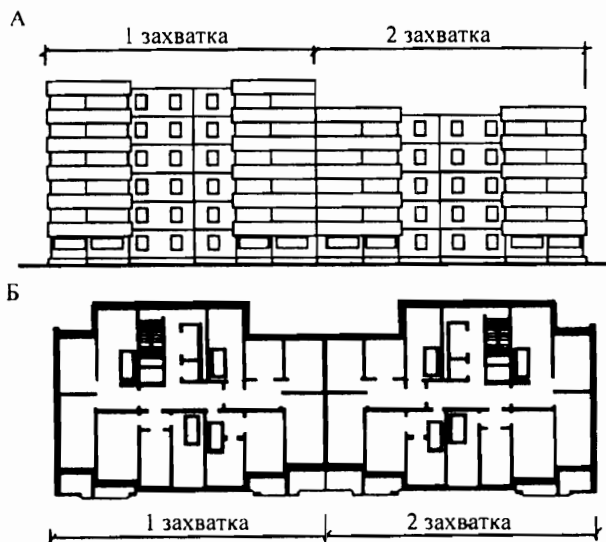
Схема разбивки многоэтажного двухсекционного здания на захватки: А - по высоте в возводимом здании; Б - в плане
